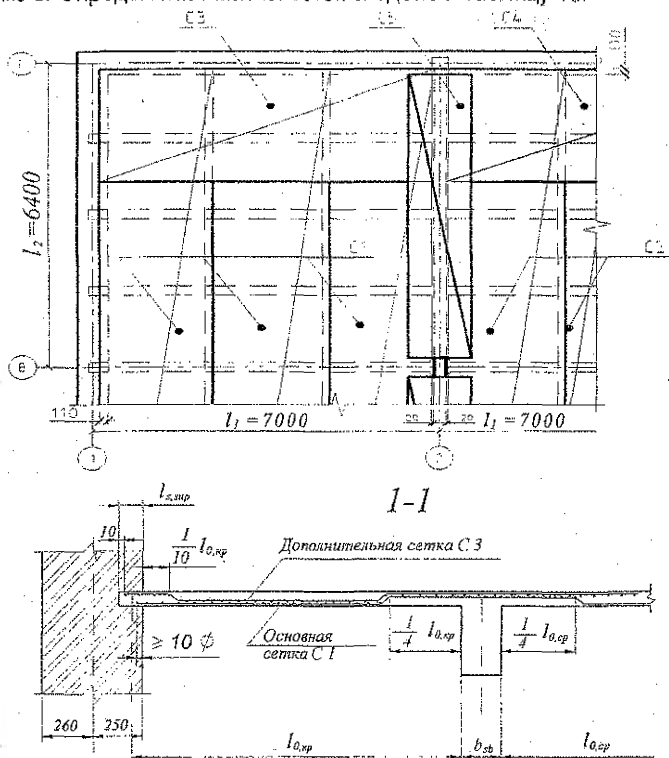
Непрерывное армирование монолитных неразрезных плит сварными рулонными сетками
